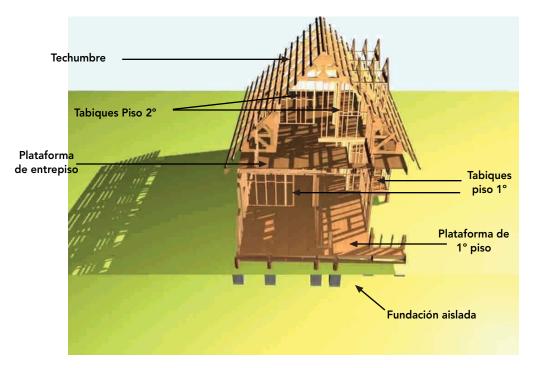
1 : Corte de la vivienda específicando sus componentes estructurales principales.
